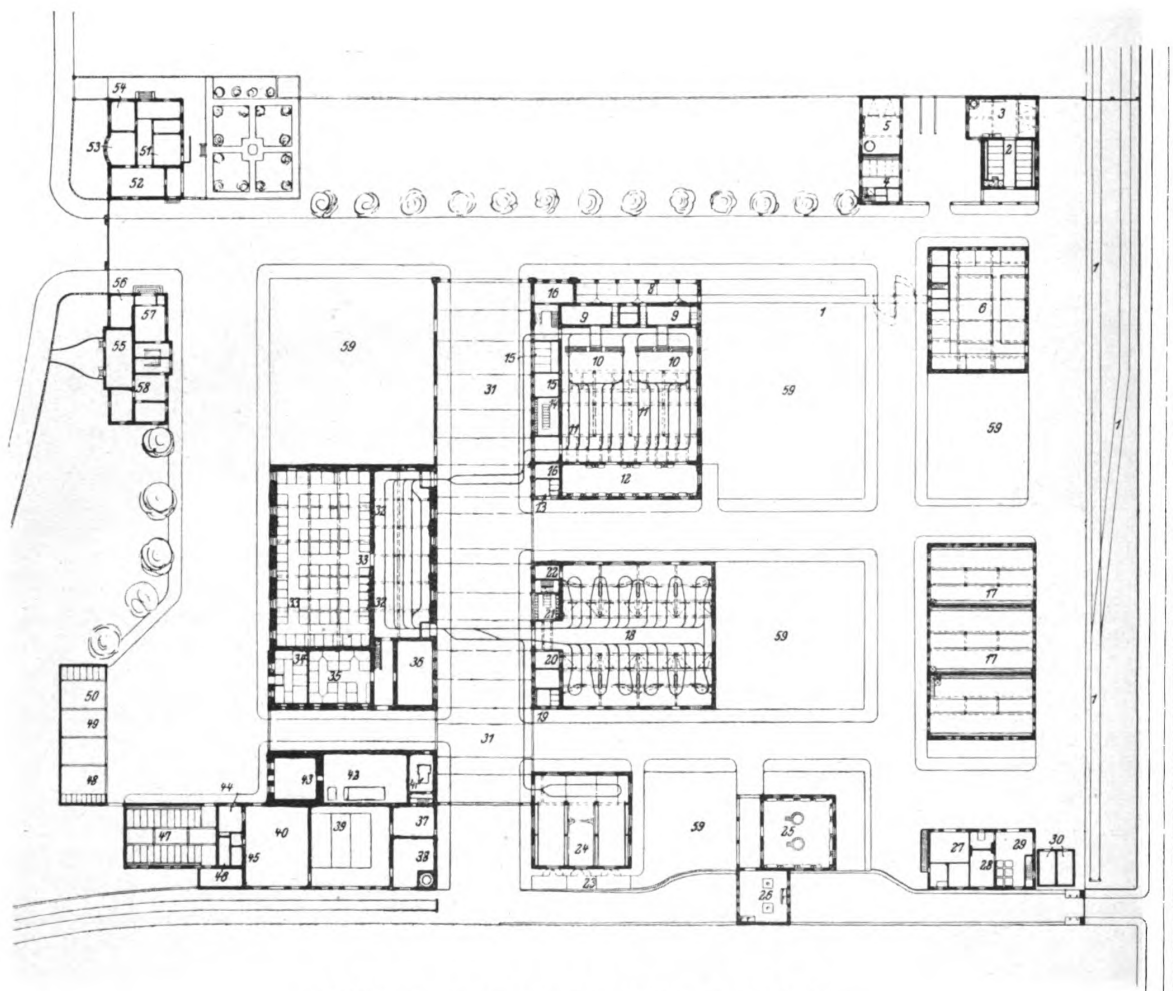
Lageplan der Schlachthof-Anlage der Stadt Worms.
